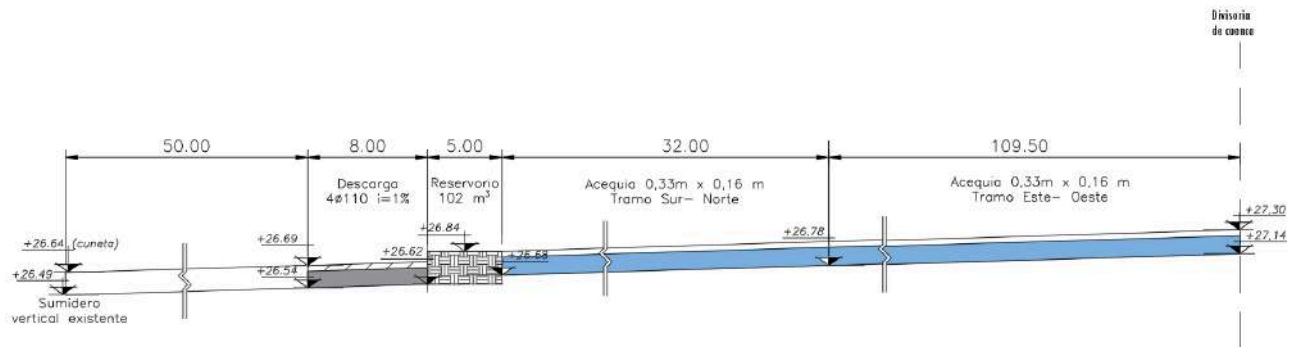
Perfil longitudinal hidráulico - Ver plano "G-01:Perfiles de Obra Básica y Pavimentos".
